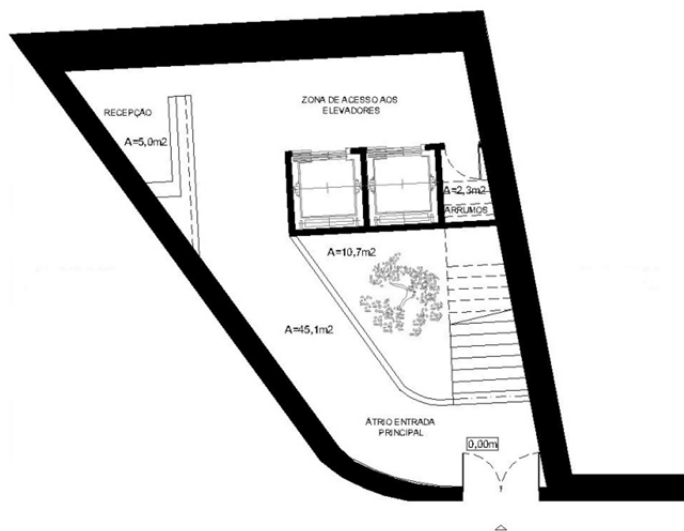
Planta do Projecto de Reabilitação, Piso 0
